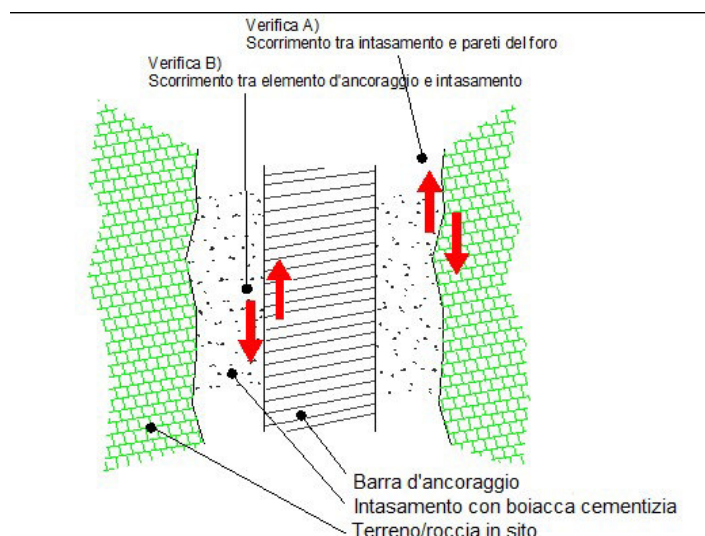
Verifiche rispetto allo sfilamento dell'ancoraggio.
